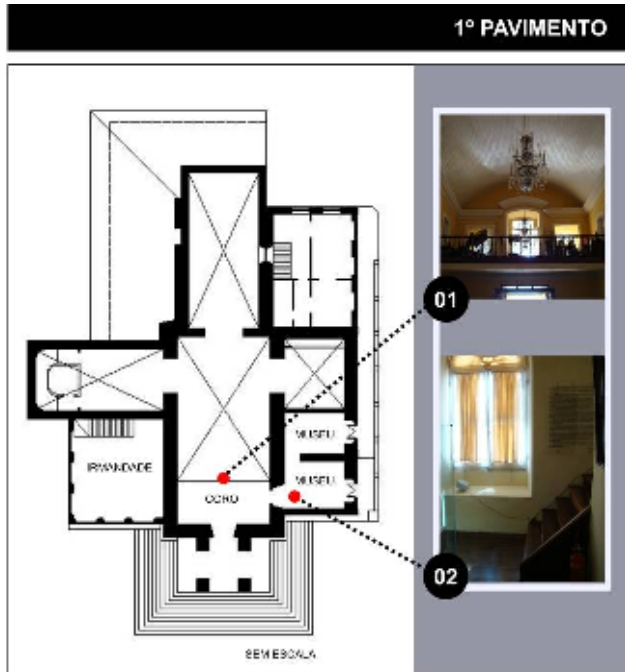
Planta primeiro pavimento. Fonte: Autora (2009).
